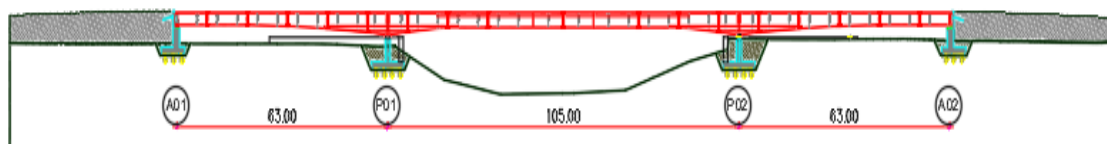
Configuração longitudinal do tabuleiro misto (dimensões em m). Adaptado de [40]
